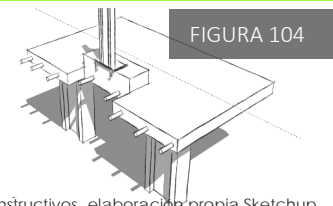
Sistemas constructivos, elaboración propia Sketchup.
